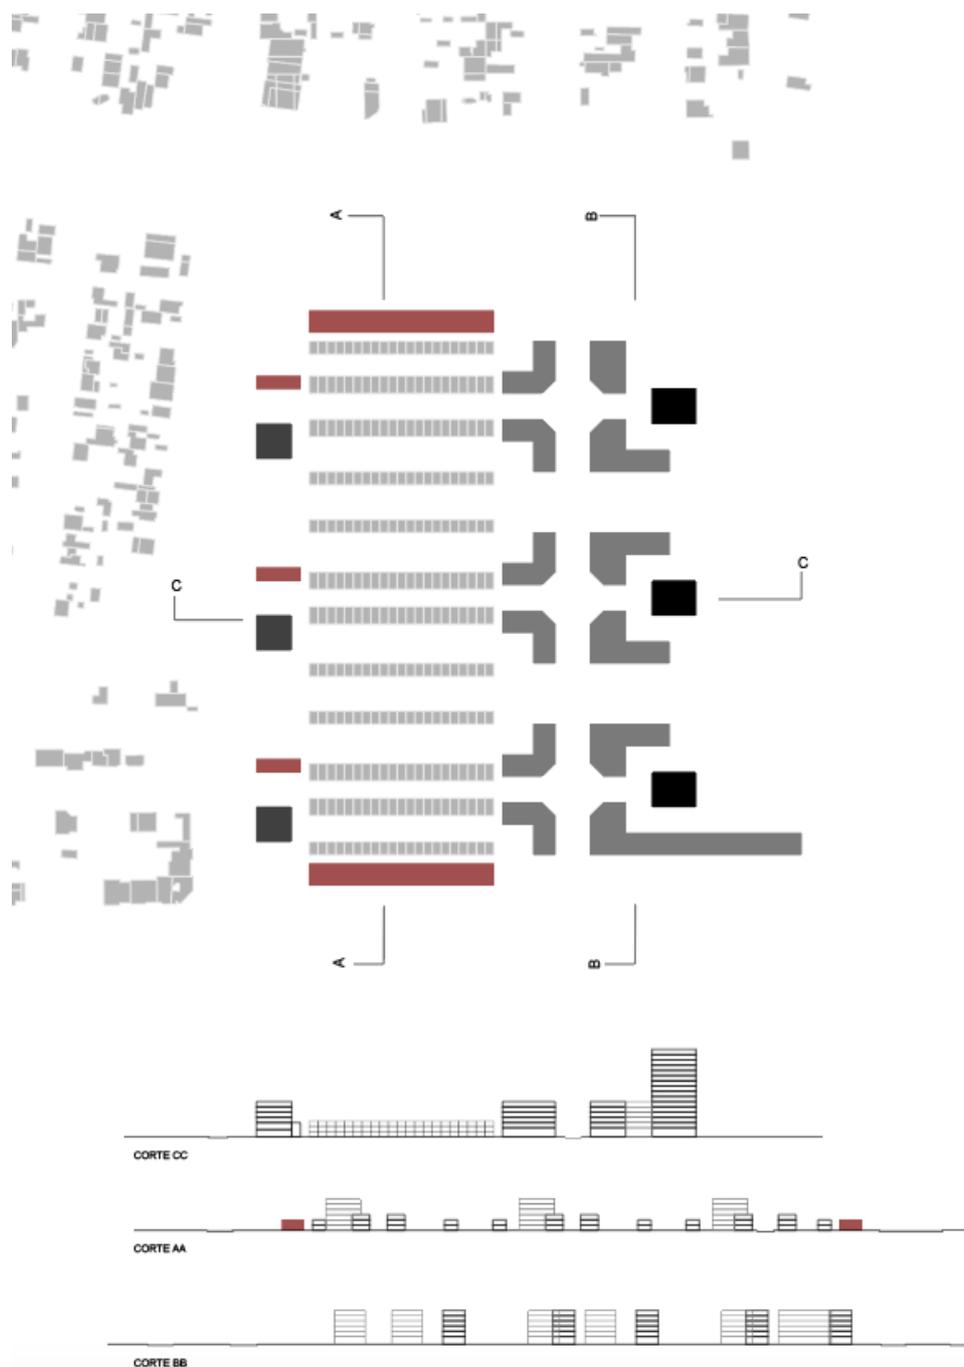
Fig. X. Edificación. AUP en Funes. Fuente: elaboración propia
